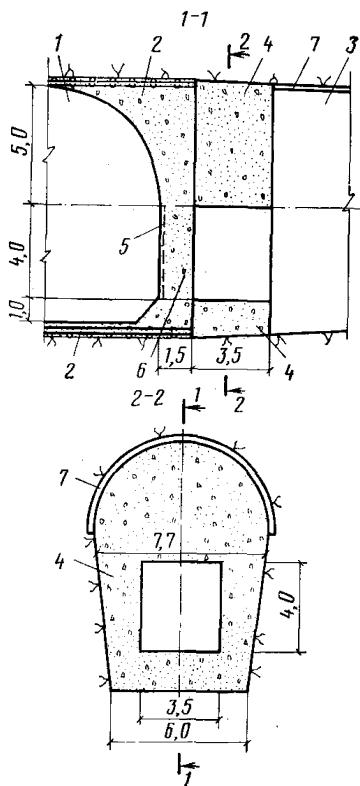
Конструкция бетонной пробки в подходной выработке:
